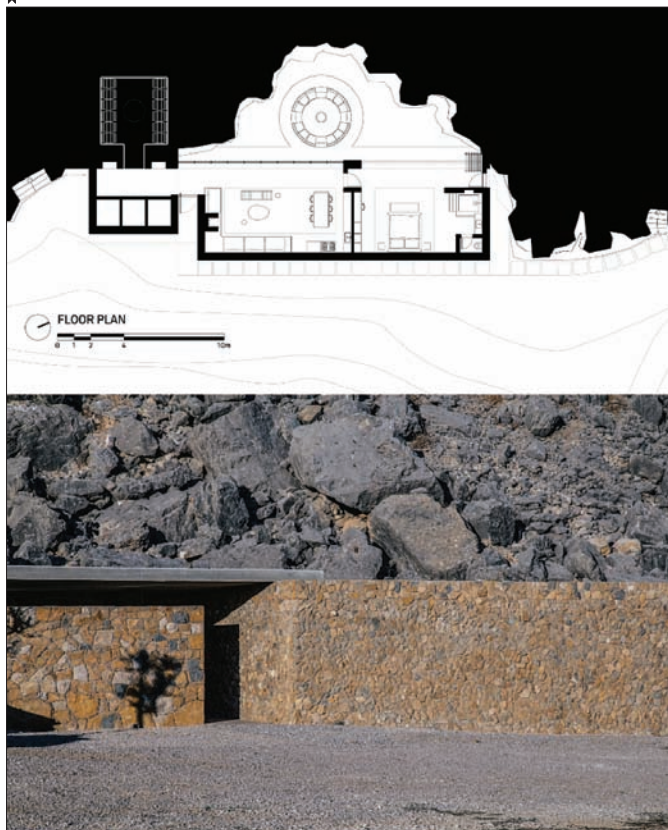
, 18: Cana Guesthouse, Bhandoum, Liban, plan / Carl Gerges Architects - stereotomie
